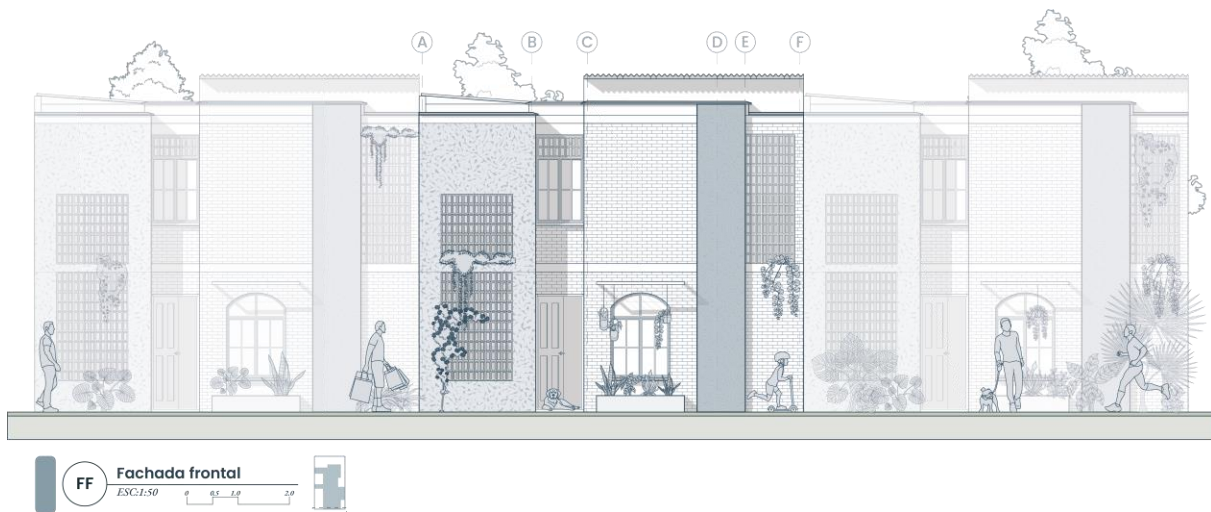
Fachada frontal Casa Patio. Elaboración propia.
